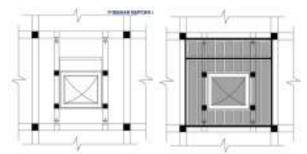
Световой колодец: а)план расположения ригелей светового колодца б) план светового колодца с остеклением
